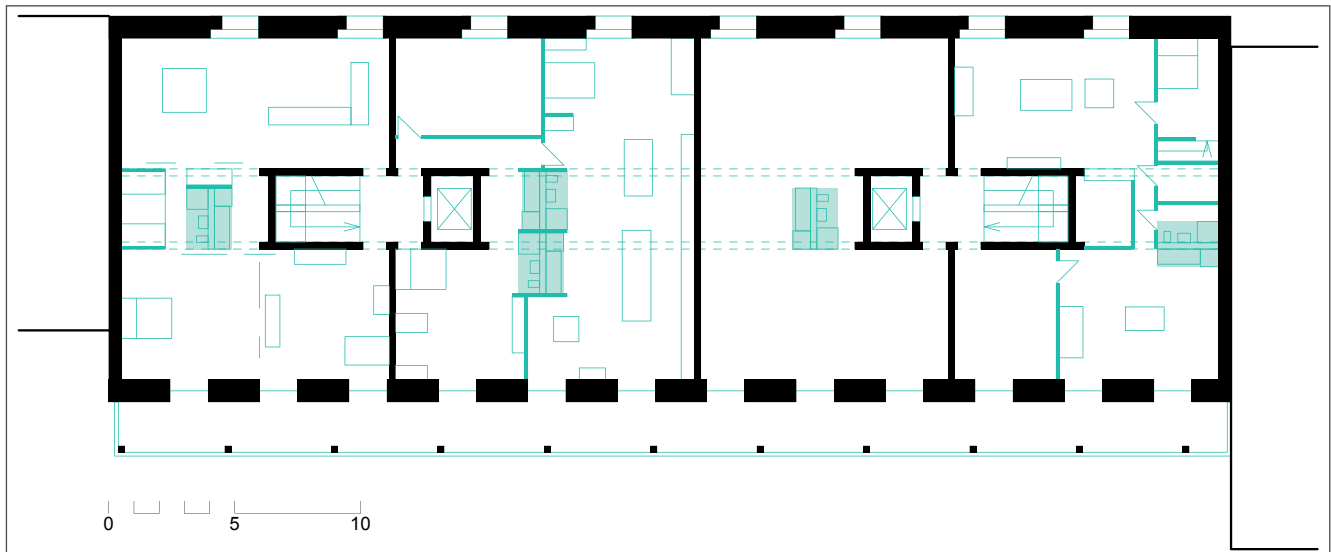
Grundrisse der Einheiten (in Schwarz) mit Selbstausbau und frei positionierbaren Sanitärelementen (in Grün) © Degelo Architekten, Bearbeitung subsolar
